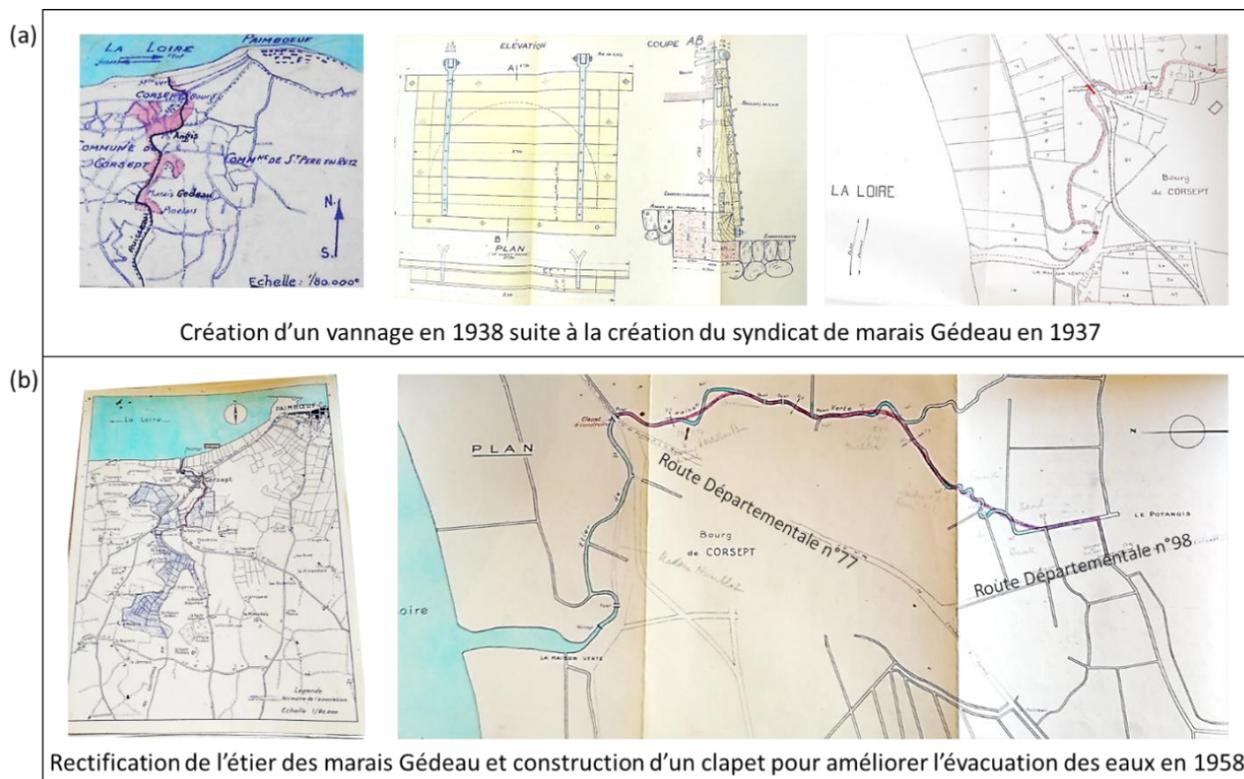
(a) : Création du syndicat de marais de Gédéau en 1937 et plan de la construction d'un vannage en 1938, (b) : Plan de recalibrage de l'étier du marais Gédéau afin d'améliorer la bonne évacuation des eaux
